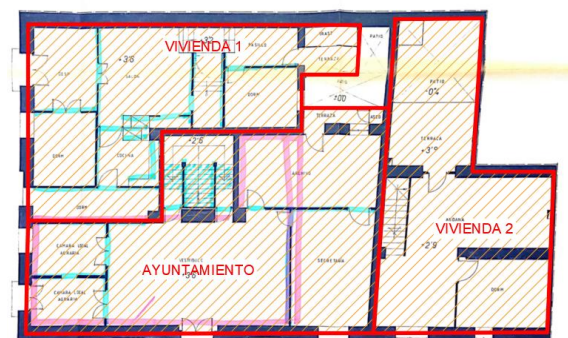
Plano viviendas. Planta primera. Junio 1984. Fuente: Plano estado actual. Junio 1984, consulta 22/04/2019
